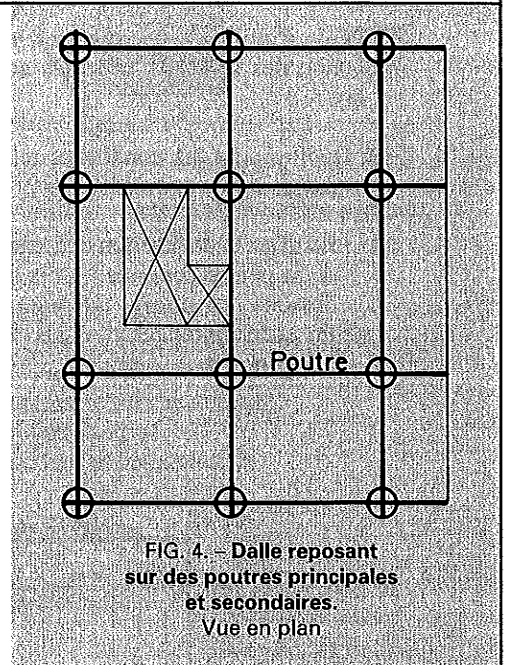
Dalle reposant sur des poutres principales et secondaires.
